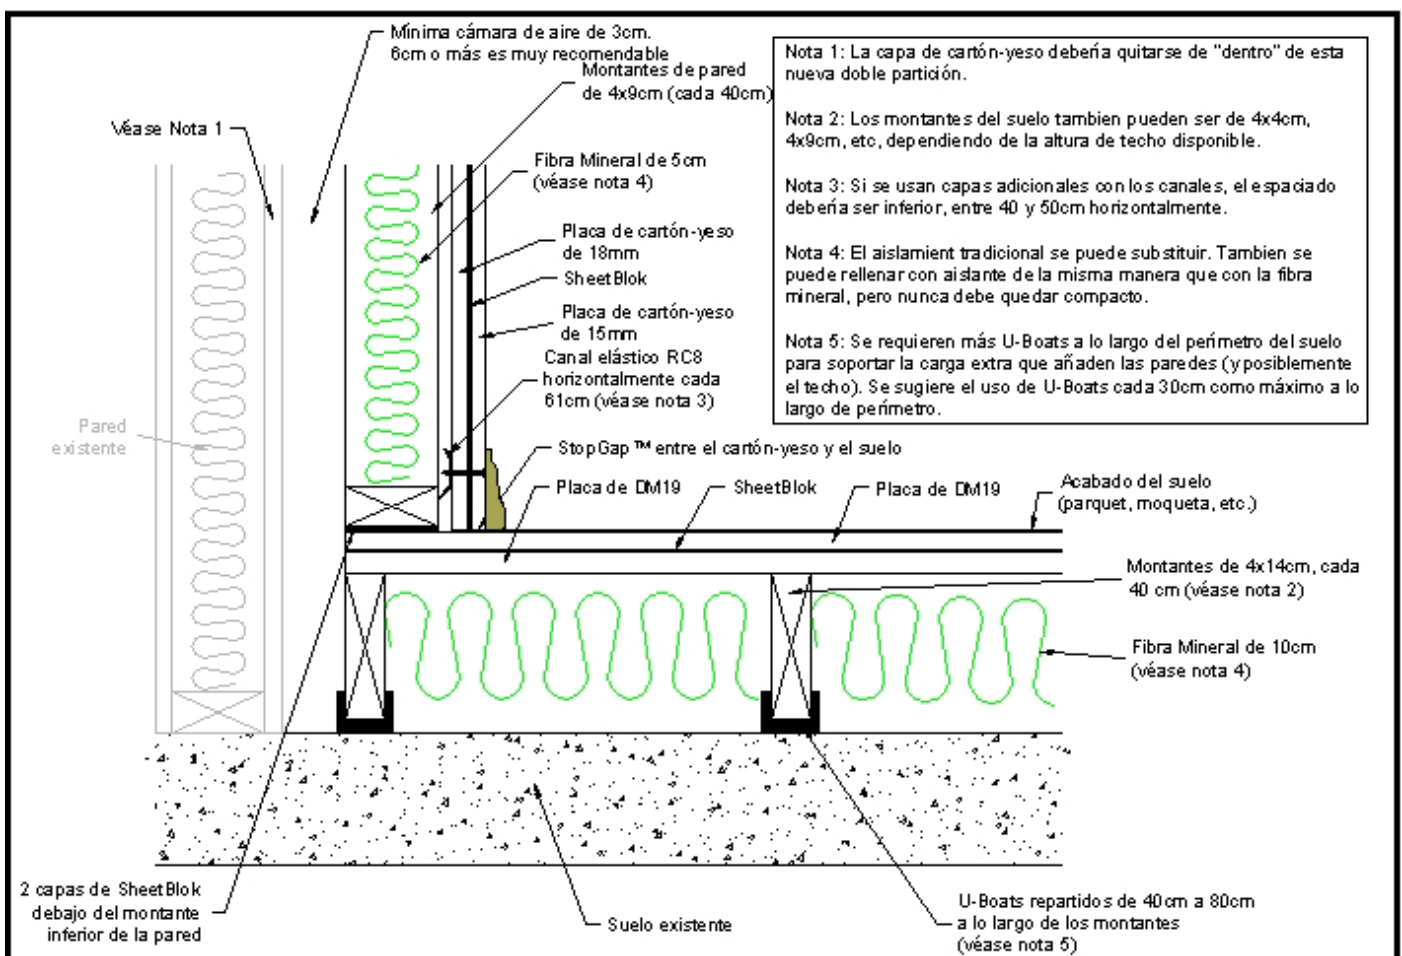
Construcción de paredes/suelo con las paredes descansando sobre el suelo flotante.
